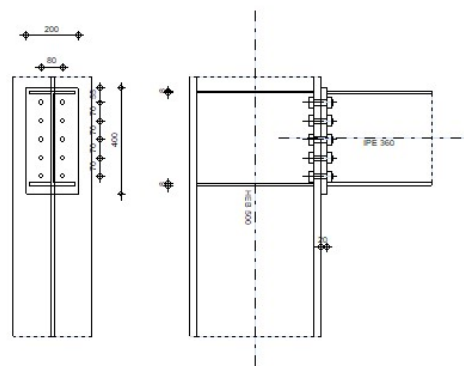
Vérification d'assemblage poteau-poutre par ROBOT
